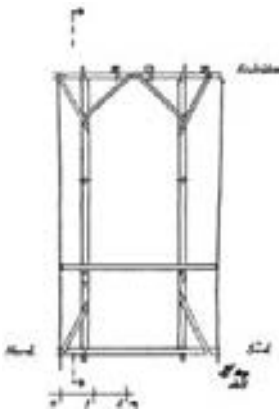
Villingen, Obere Straße 25. Längsschnitt durch das Dachwerk von 1312(d).
